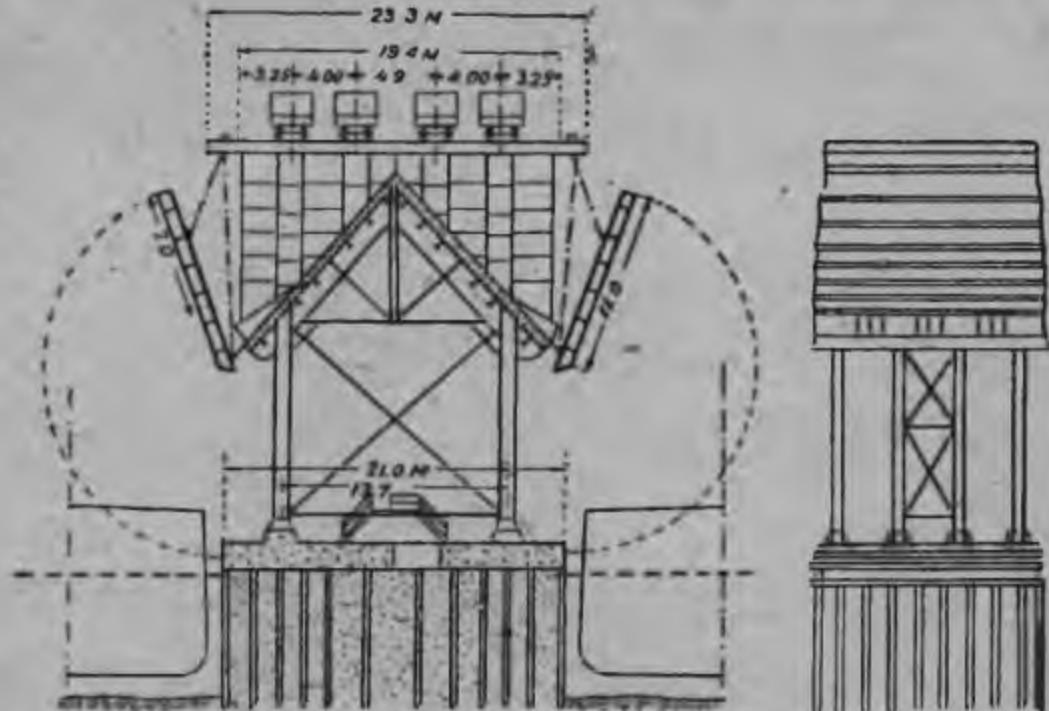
Железобетонная погрузочная эстакада для ссыпки угля или руды из вагона в бункера и суда.
